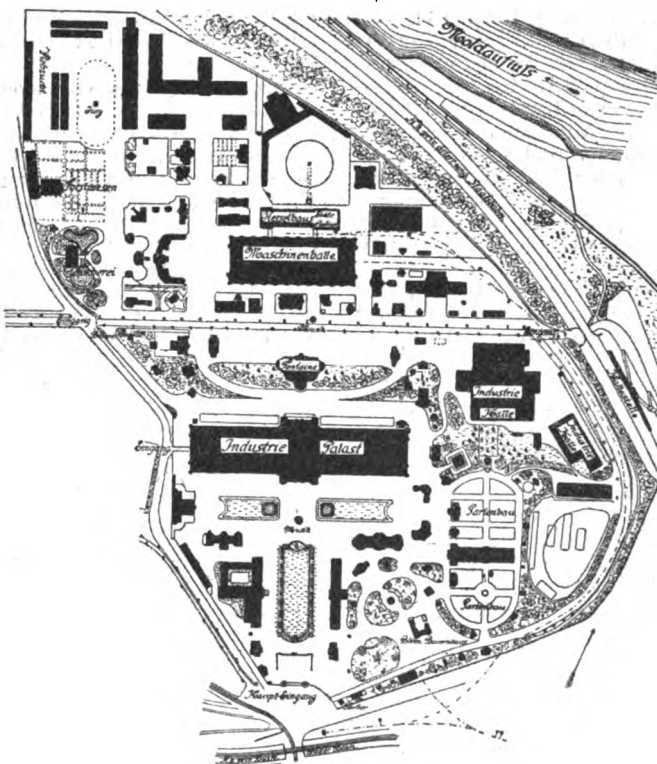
Plan der Allgemeinen Landes-Ausstellung in Prag.
